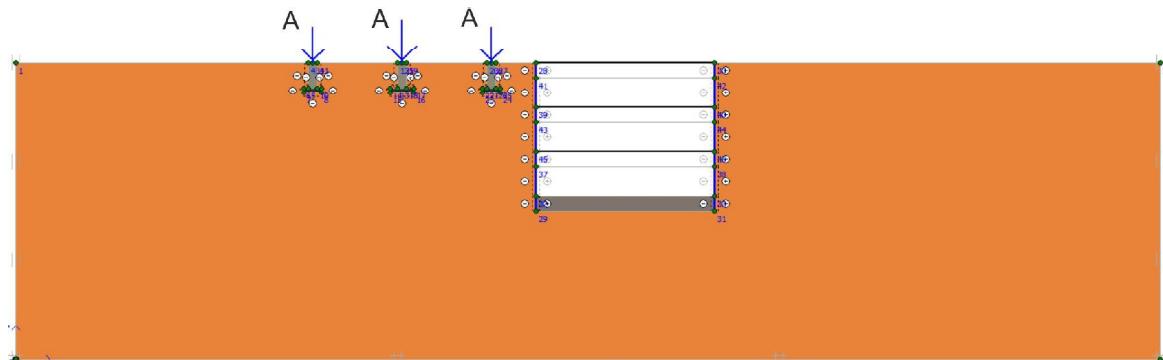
Расчетная модель устройства котлована открытым методом 2-м способом (с устройством плиты jet-grouting по дну котлована)
